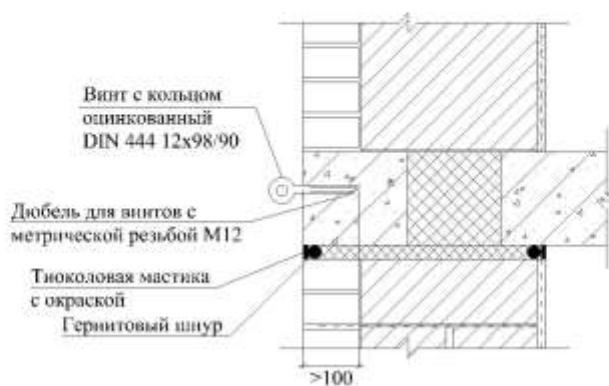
Крепление навесных устройств к фасадам стен
